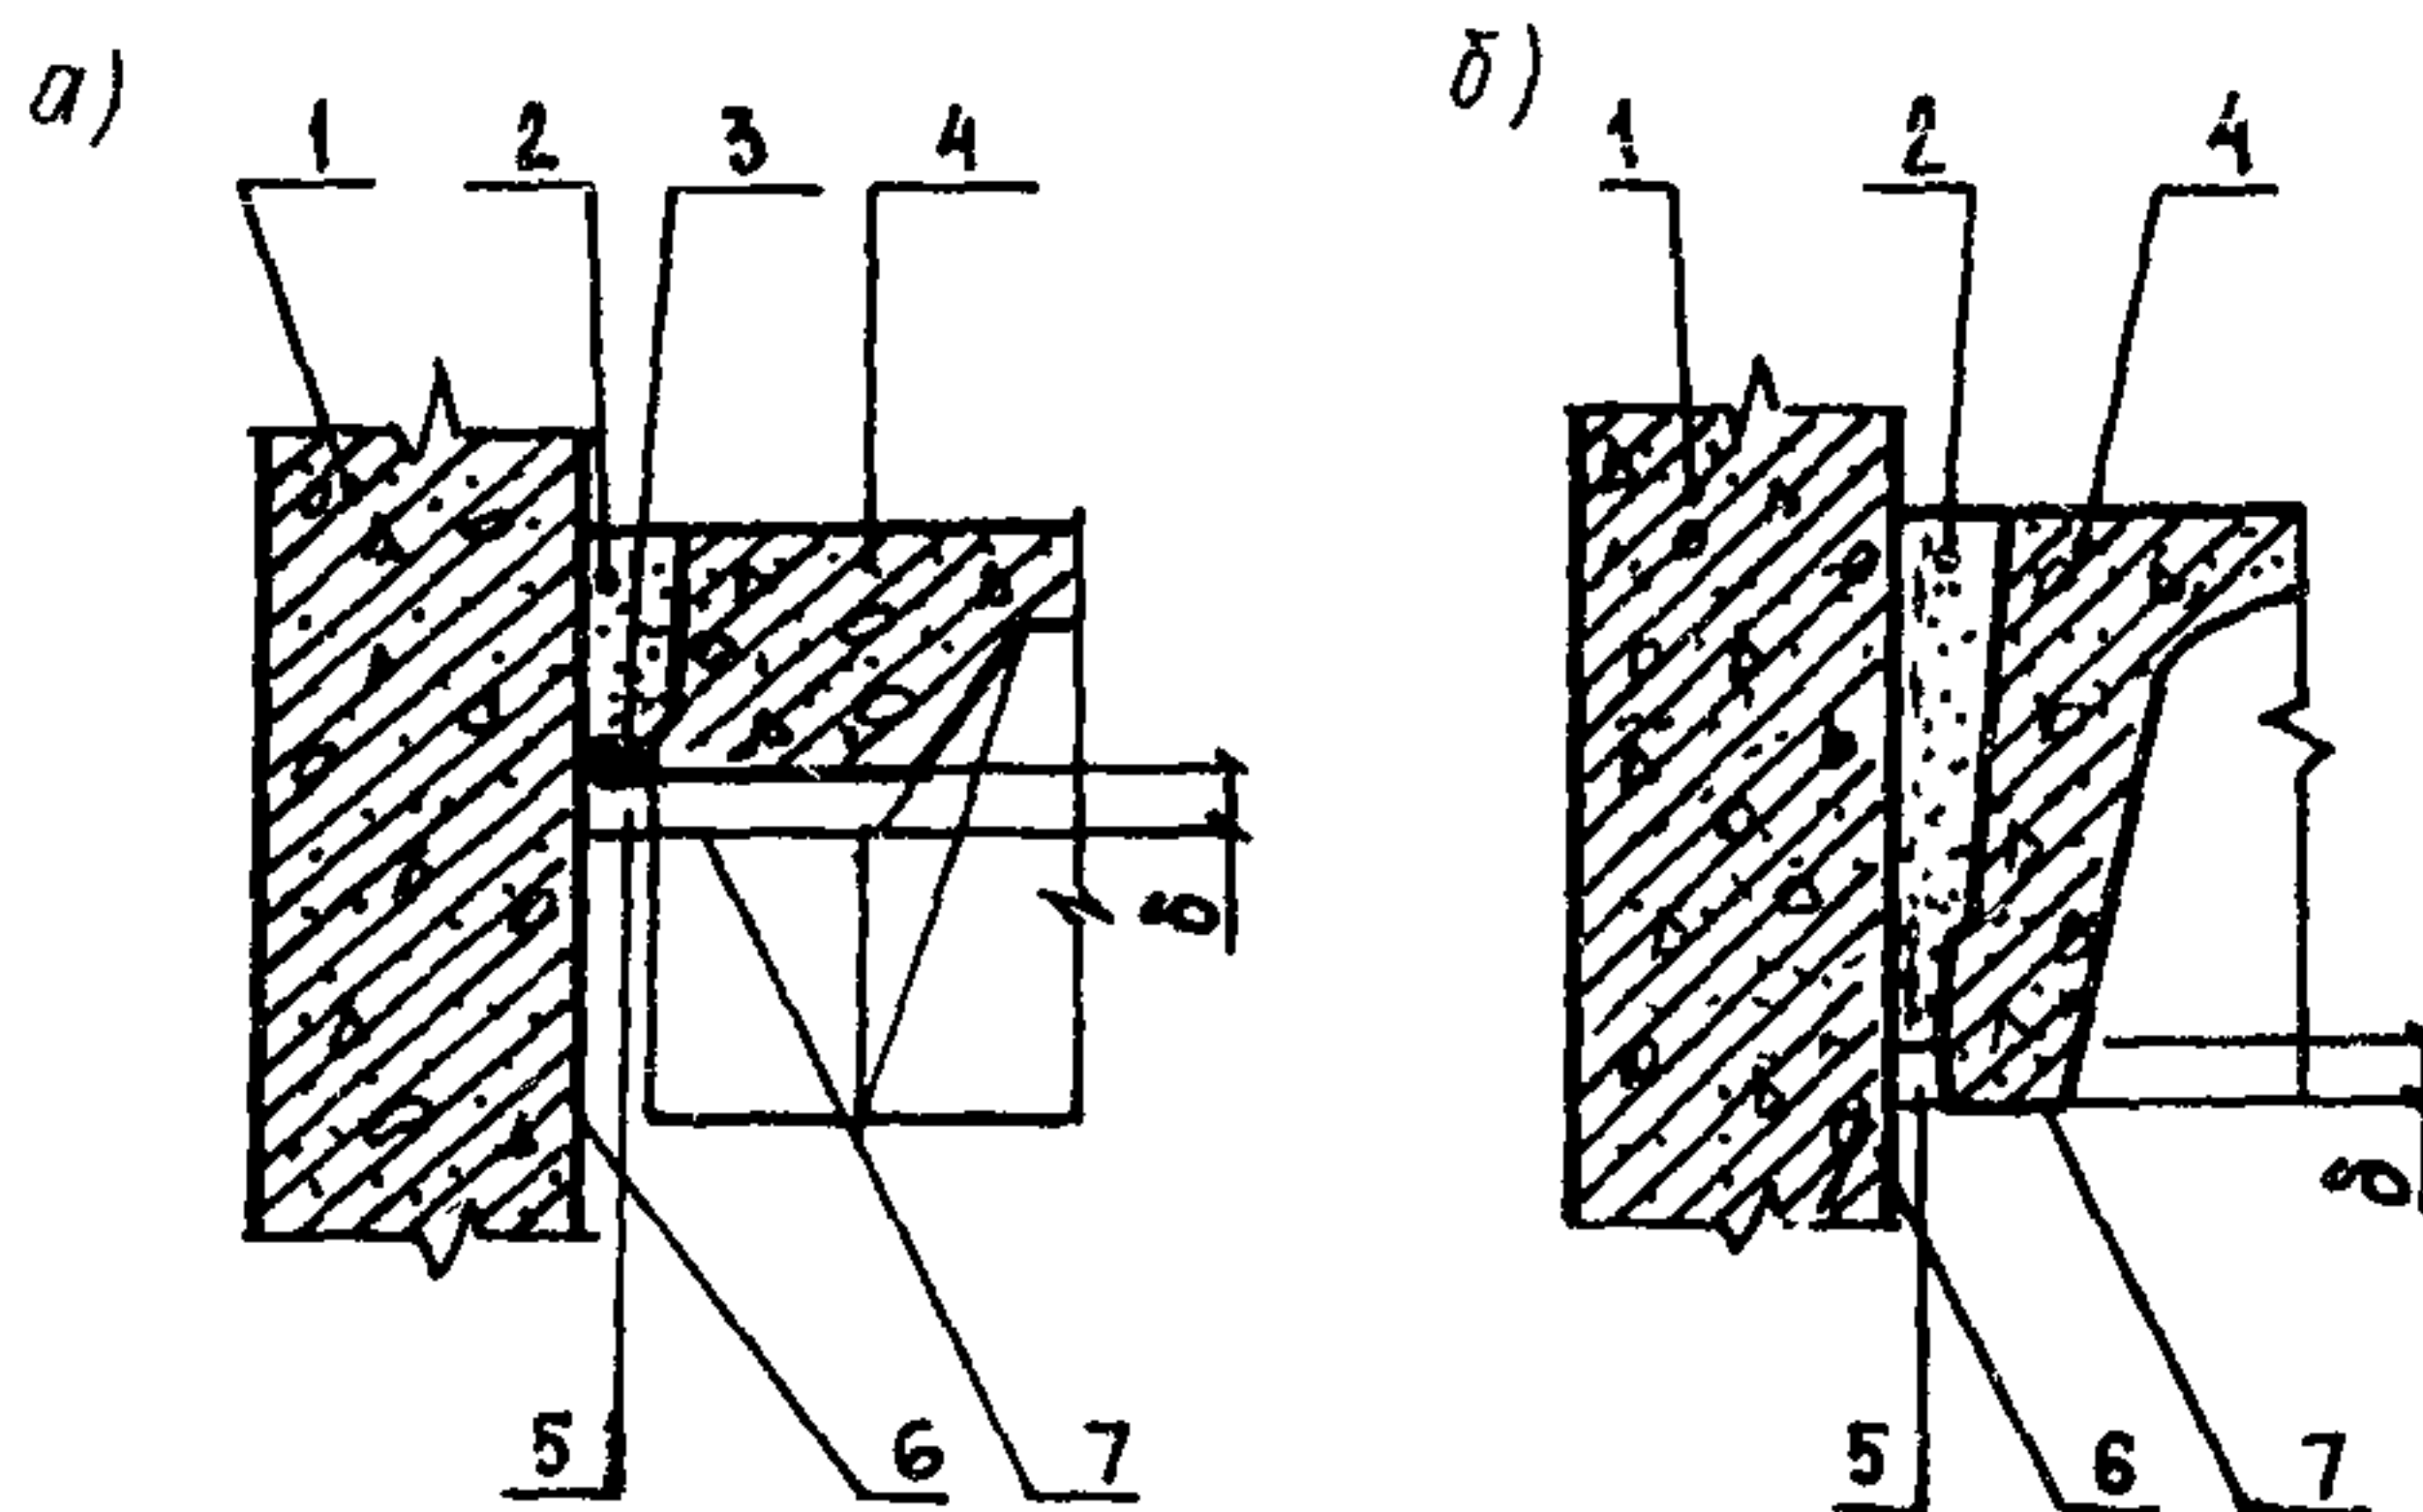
Узел сопряжения плит покрытия с наружными стеновыми панелями
